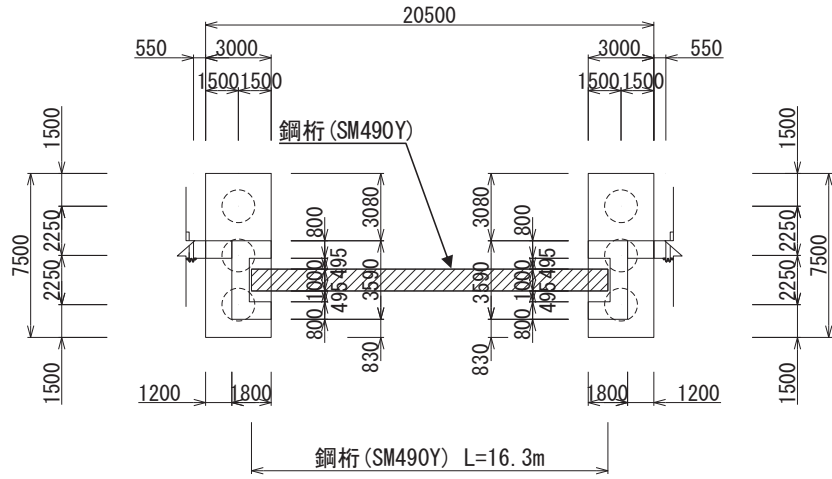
(2) 鋼製遮水壁（鋼桁 6） 平面図
